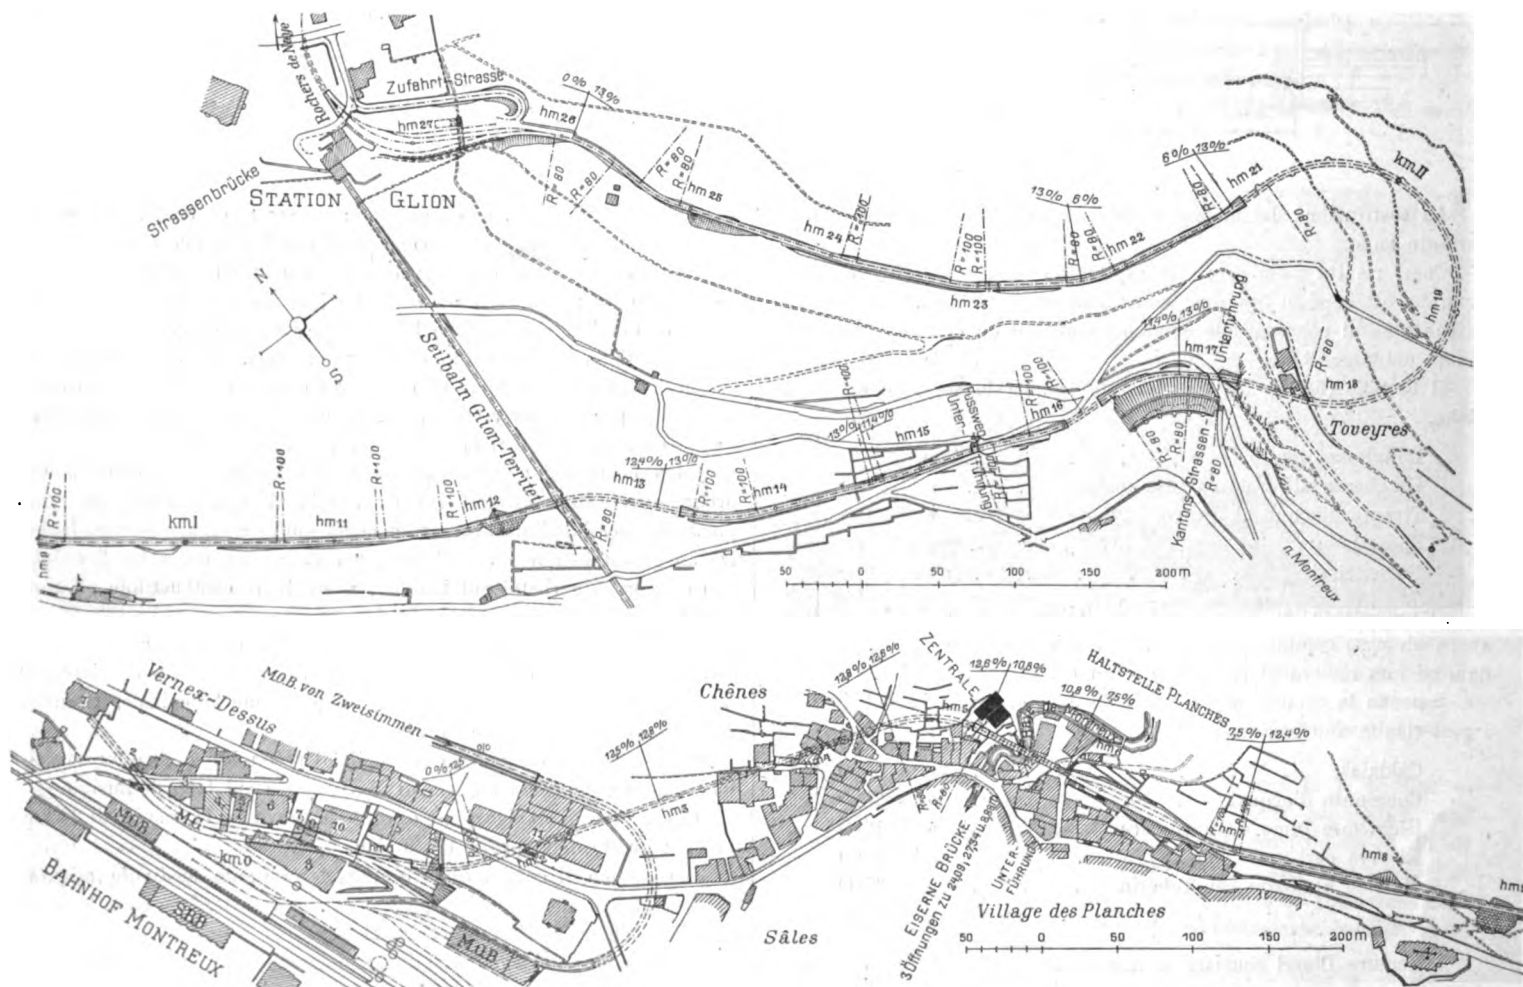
Ferrovia a dentiera Montreux-Glion. - Planimetria.
